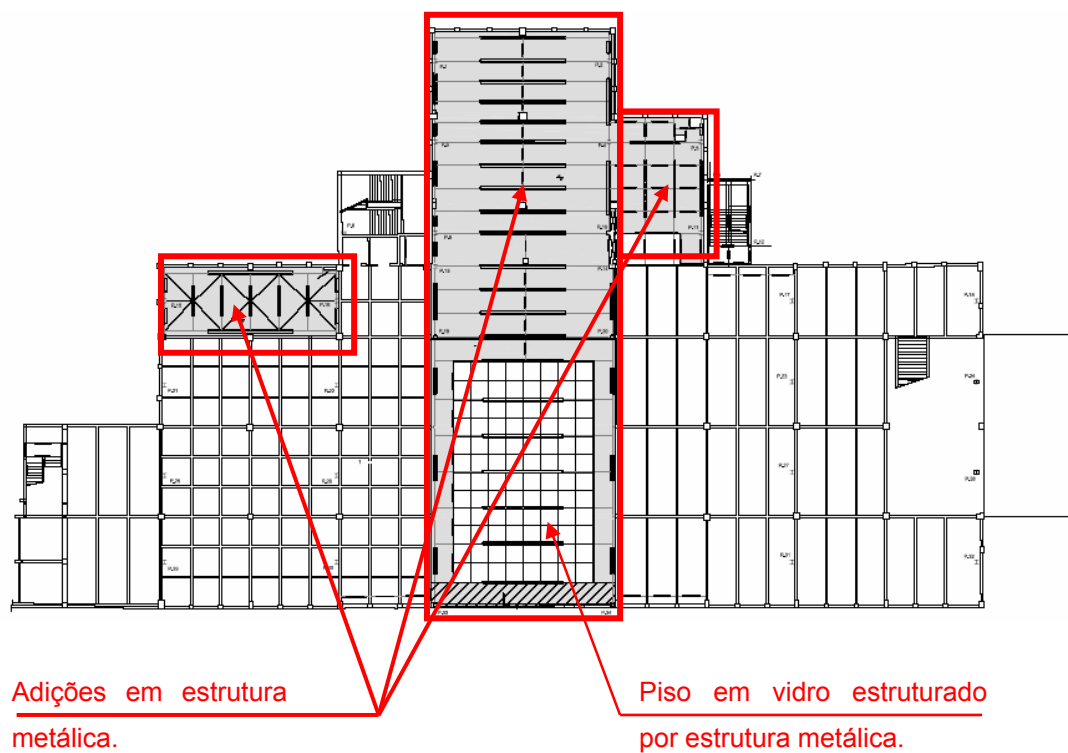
Estrutura metálica do piso do pavimento térreo superior.
